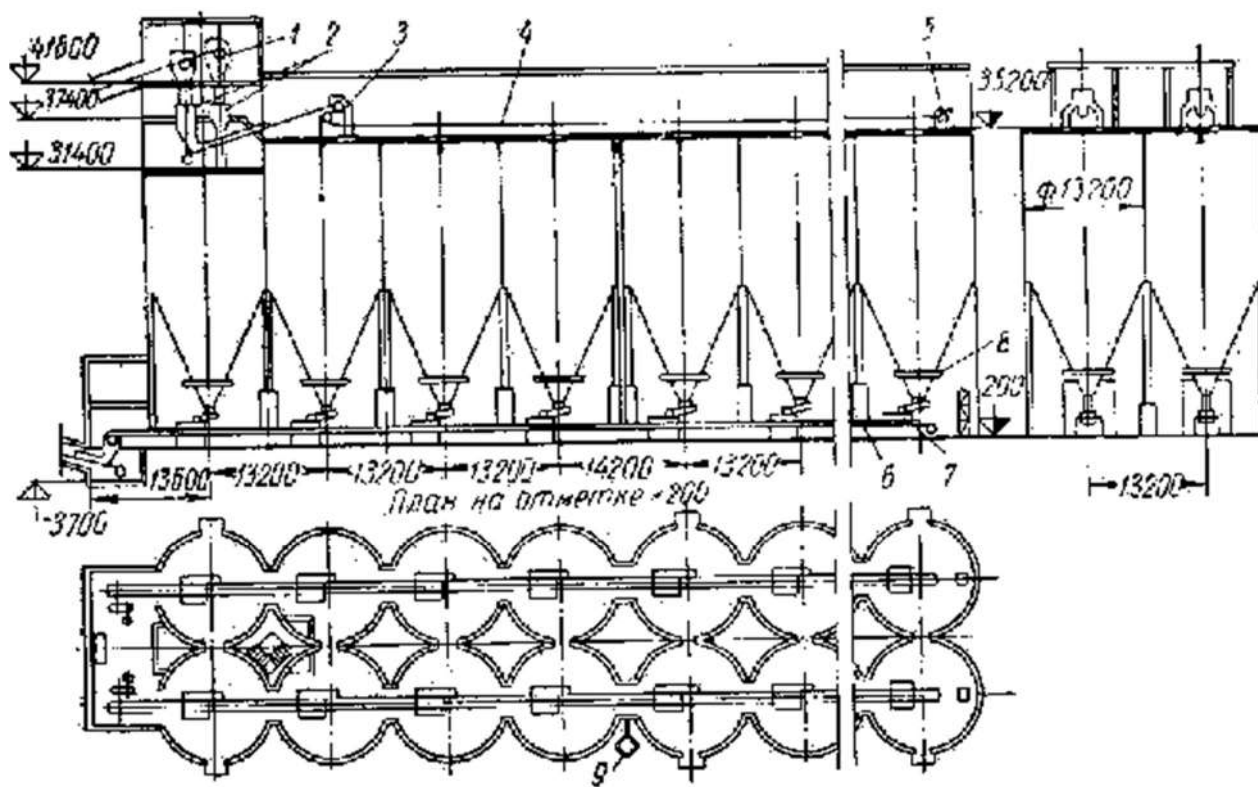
Схема закритого складу (1 - минаючі конвеєри; 2, 4 - конвеєри; 3 - розвантажувальний візок; 5 - ринва; 6 - збірний конвеєр; 7 - автодозатор; 8 - пристрій для пневмообрушення; 9 - ресивер стисненого повітря для пневмообрушення
